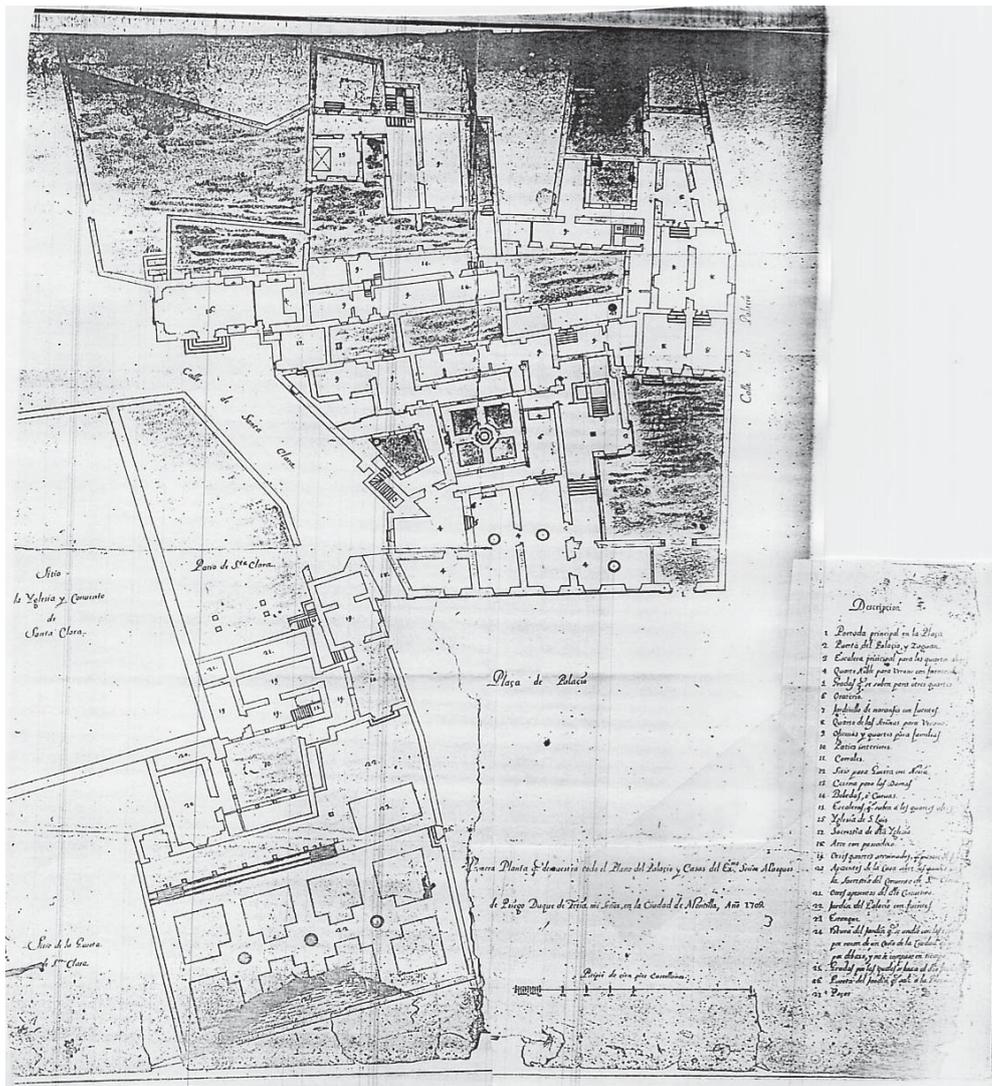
FOTO DEL PLANO DE PLANTA BAJA DEL PALACIO DE MONTILLA EXISTENTE EN EL ARCHIVO DE LA CASA DE MEDINACELI, EN SEVILLA.
